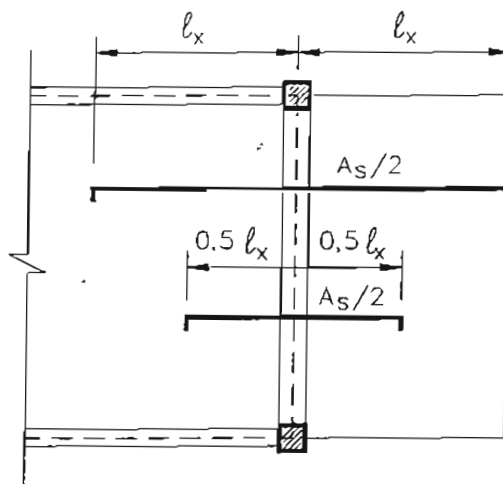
Arranjos de armaduras para lajes em balanço, segundo Texto Base para Revisão da NB 1/78 (1997)
